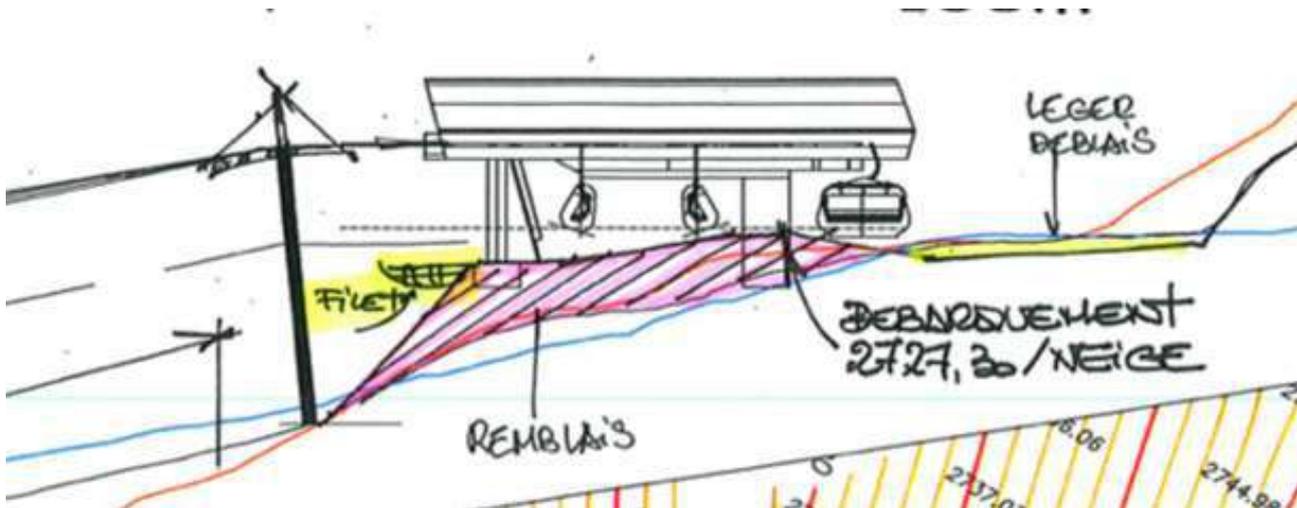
Gare amont, extrait plan masse G2 (DCSA)
